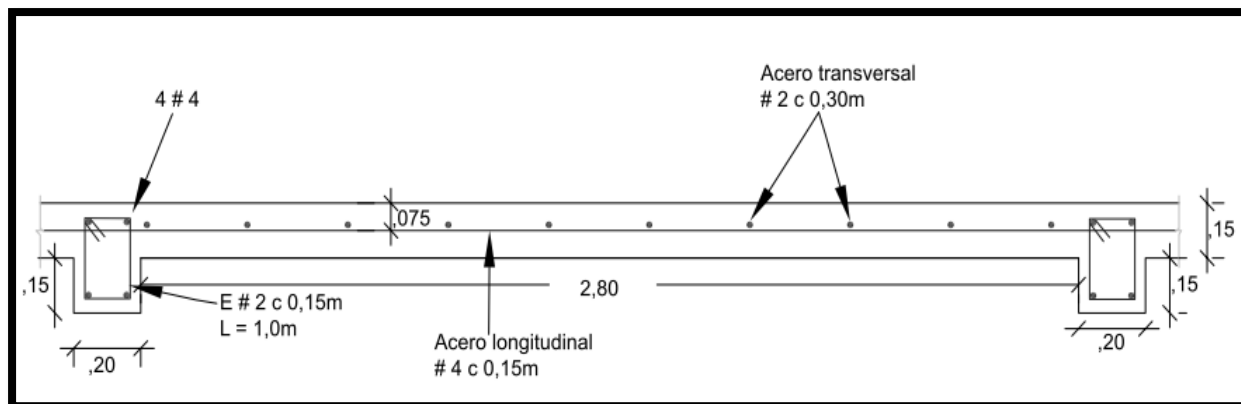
Detalle del acero de refuerzo de las vigas riostras y las losas de concreto reforzado.
